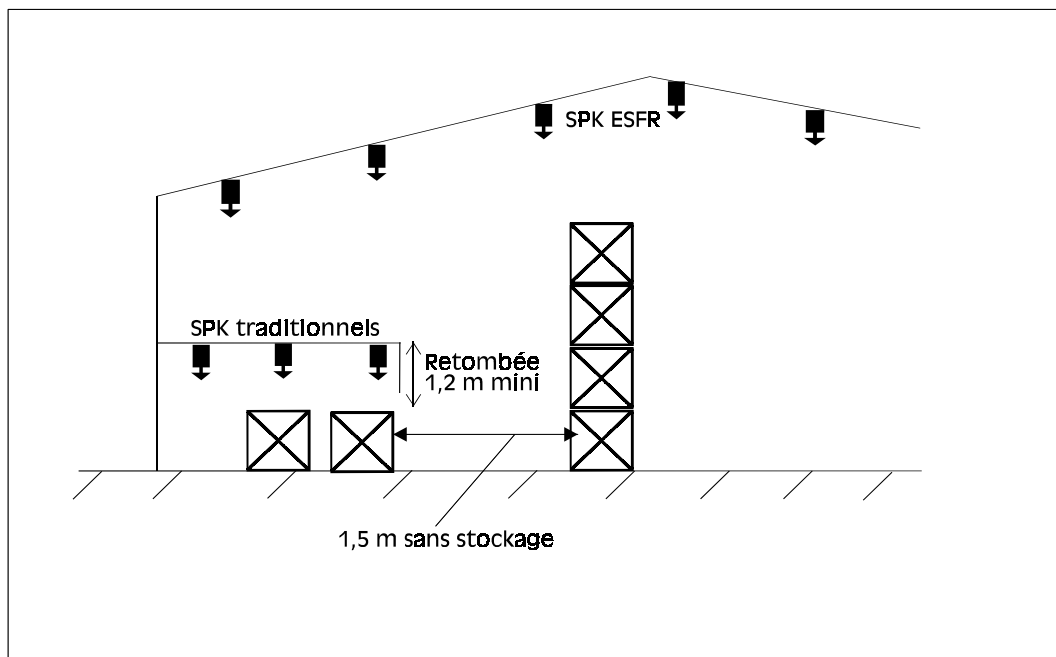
β : Protection ESFR en toiture avec mezzanine protégée en sprinkleurs traditionnels
